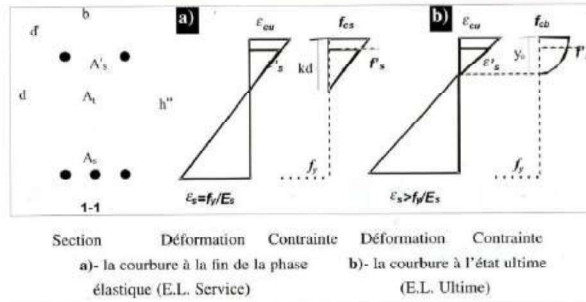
Comportement de la section d'une poutre fléchie en béton armé.
